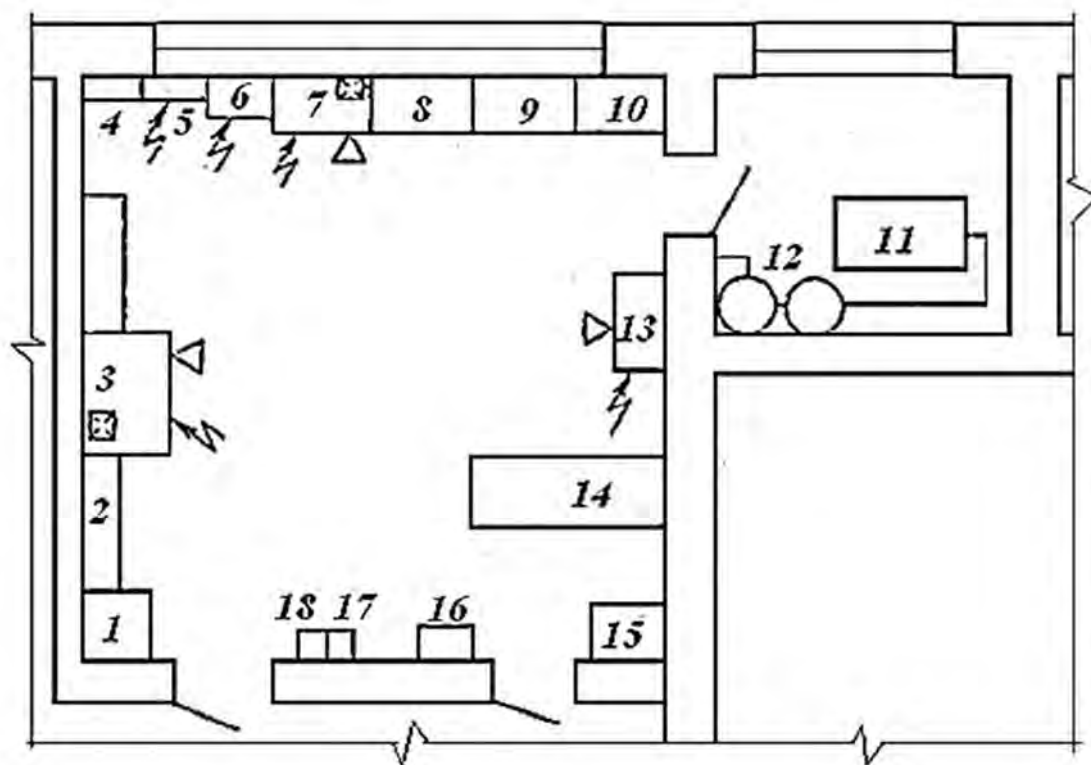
Участок ТО и ТР аппаратуры ГБА: 1 – стол приемки; 2 – стеллаж; 3 – ванна для мойки узлов; 4 – шкаф для обтирочных материалов; 5 – заточной станок; 6 – сверлильный станок; 7 – ванна для мойки деталей; 8 – пост ремонта редуктора высокого давления; 9 – пост ремонта редуктора низкого давления; 10 – пост ремонта смесителей; 11 – компрессор; 12 – ресиверы для сжатого воздуха; 13 – стенд для проверки газовых аппаратов; 14 – стеллаж для отремонтированных узлов; 15 – стол; 16 – шкаф для приборов; 17 – ящик с песком; 18 – ящик для мусора
